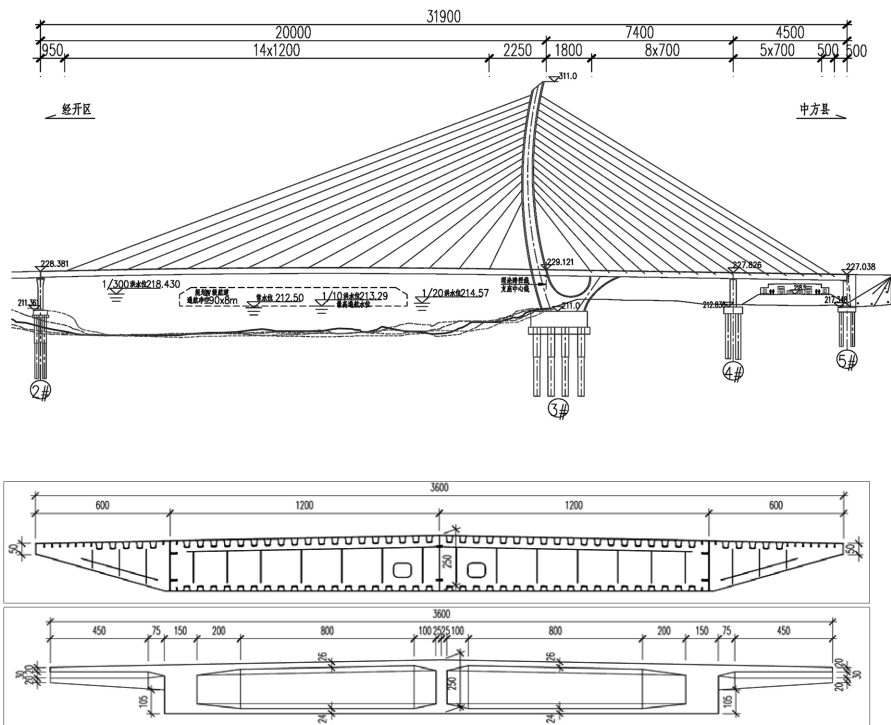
主桥桥型布置图及钢/砼主梁断面图（单位：cm）
